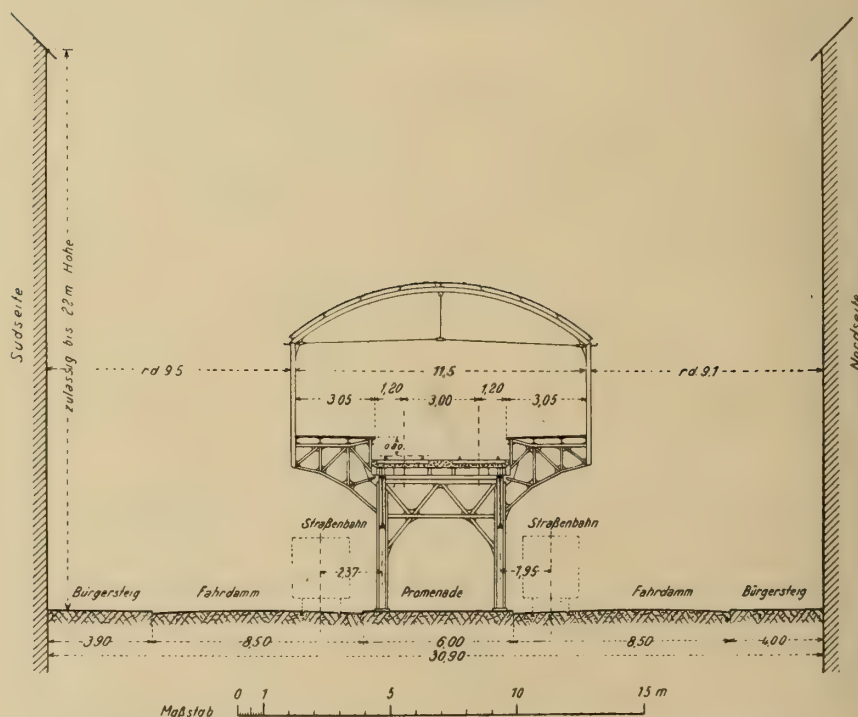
Gitschiner Straße mit Haltestelle Prinzenstraße.
